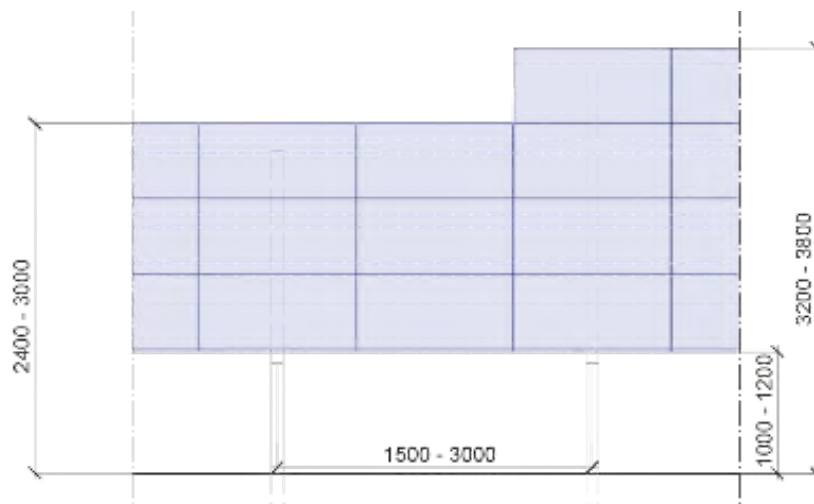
Rappresentazione grafica della disposizione particolare a 4 moduli anziché 3 moduli.
